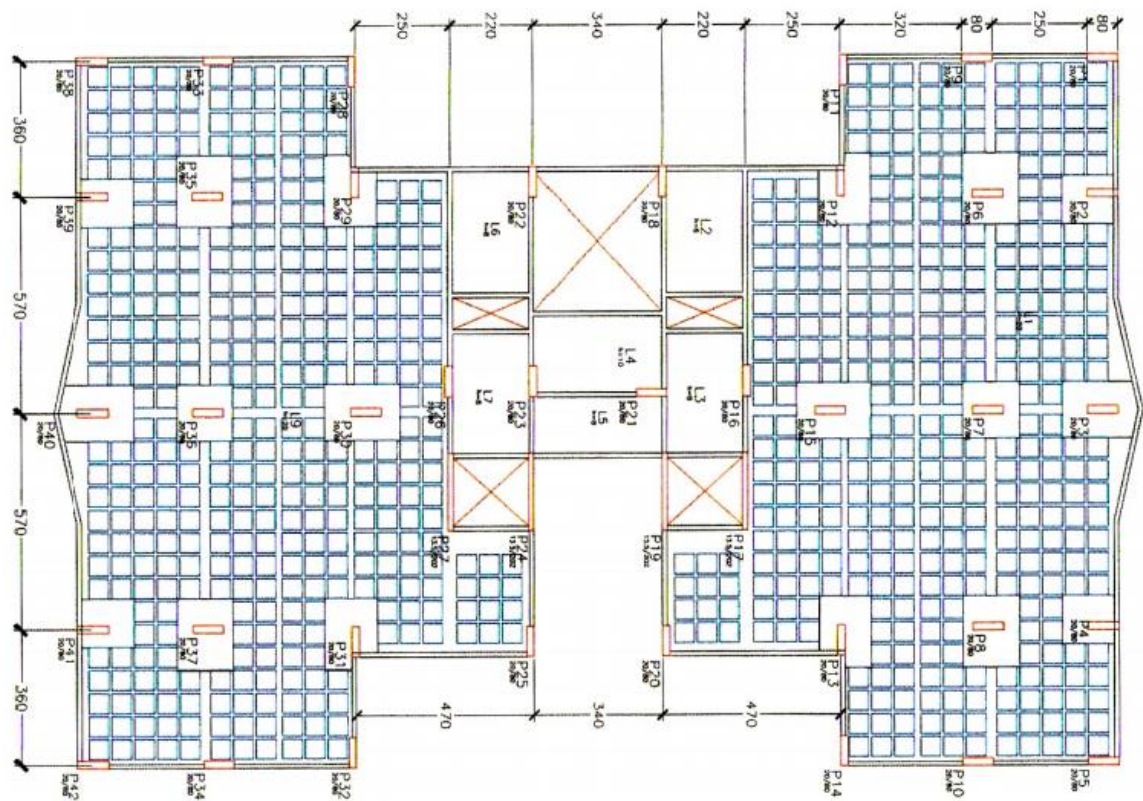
Planta baixa do segundo exemplo (MARTINS, 2003) – cotas em cm
